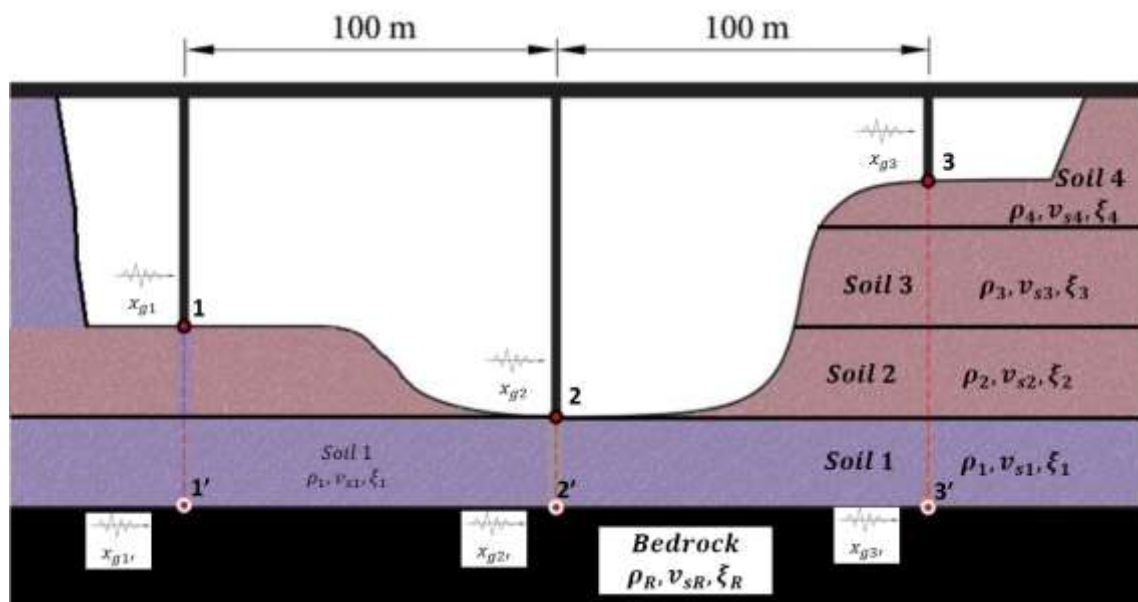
81. Schéma de d'un pont implanté sur un site multicouche.
